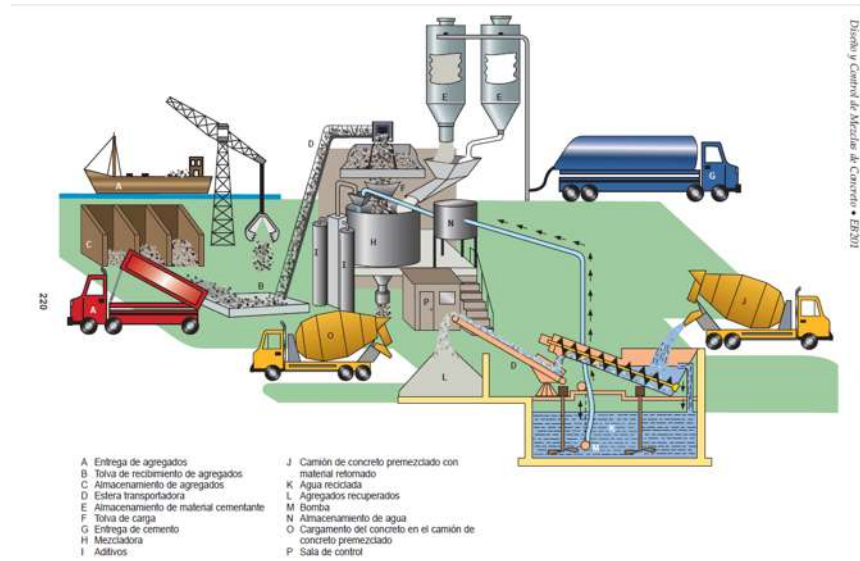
IMAGEN III – ETAPAS DE LA PRODUCCION DEL CONCRETO EN UNA PLANTA MEZCLADORA – (DISEÑO Y CONTROL DE MEZCLAS DE CONCRETO)
